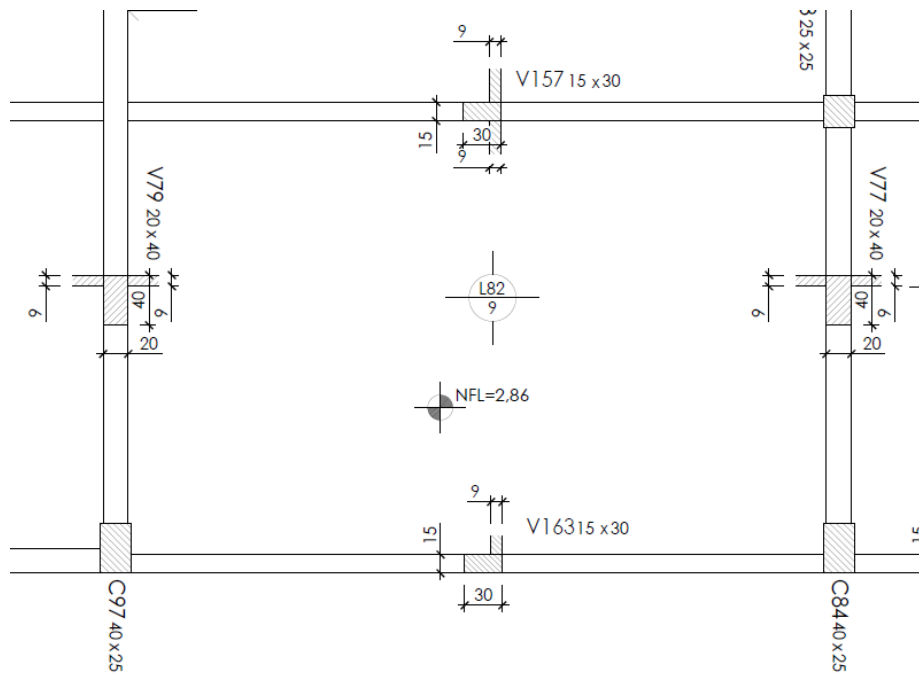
Esquema estructural losa L82 con los elementos de apoyo. (Fuente: Elaboración propia)
